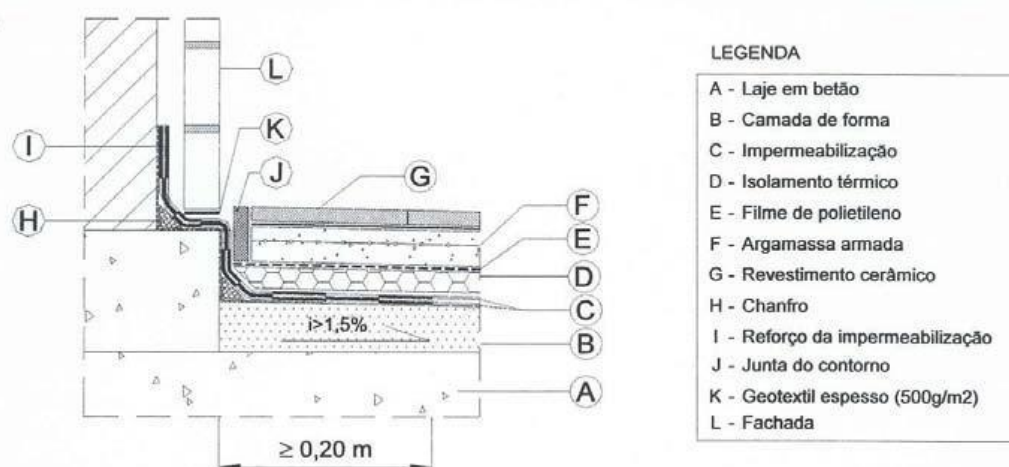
Remate do sistema de impermeabilização com a fachada ao nível da cobertura em terraço acessível com revestimento em “tijoleira tradicional portuguesa” [Caderno de Encargos]
